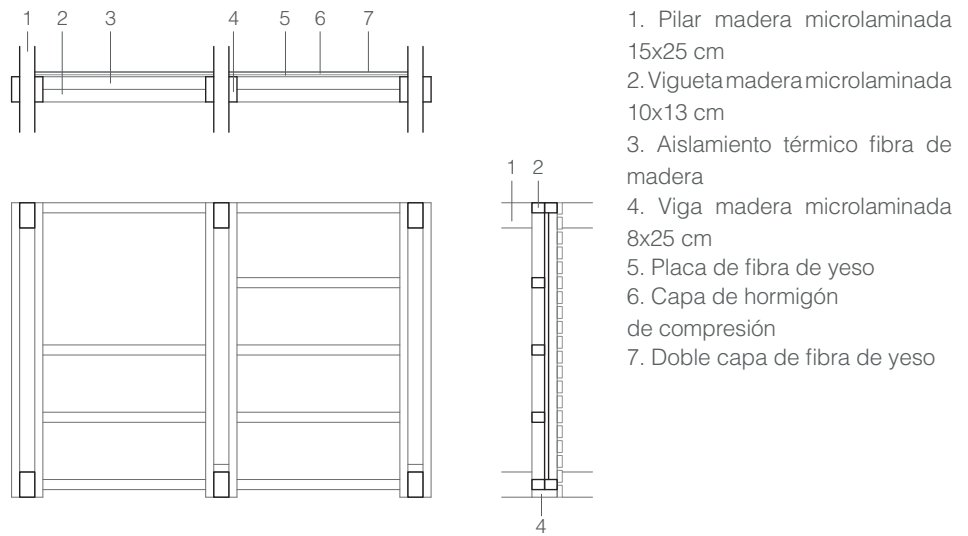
Planta estructura proyecto "Regenerar Barcelona". E 1:75
